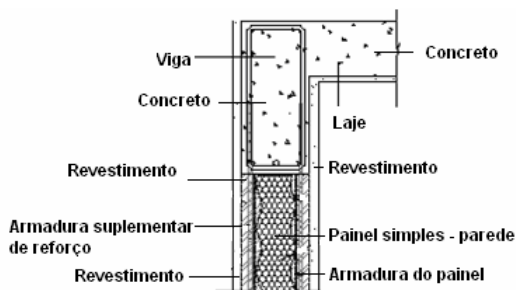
União de painel parede com viga do pavimento superior – vista em corte
